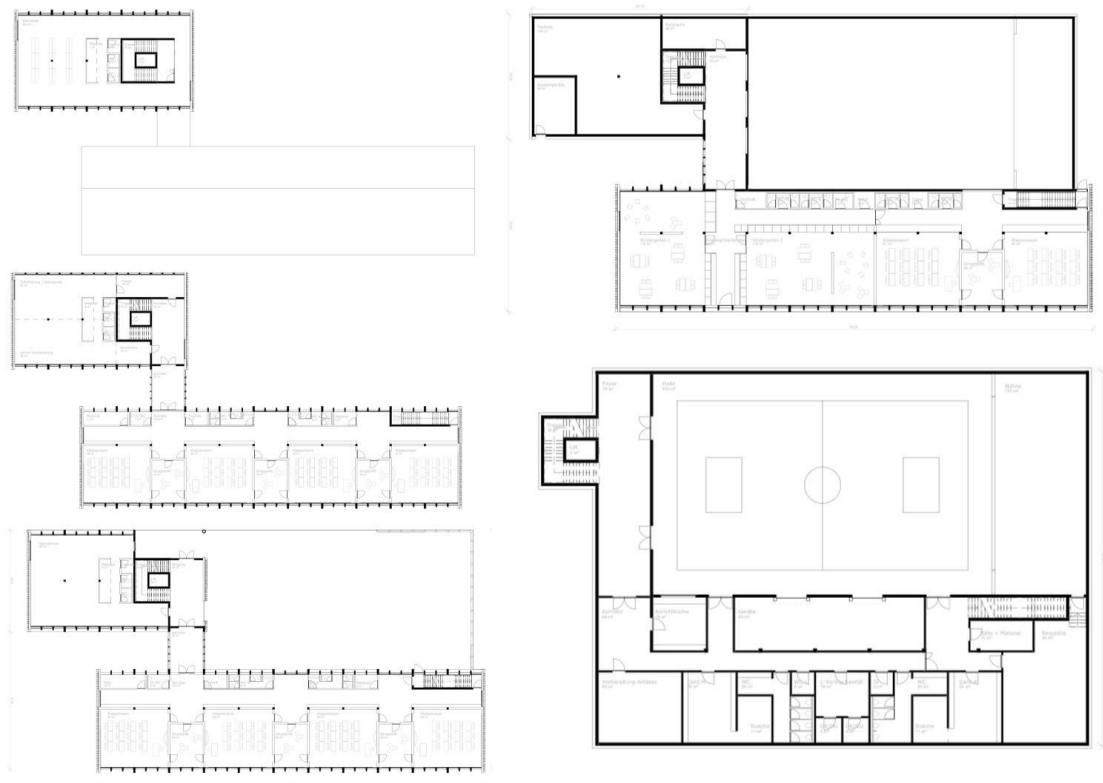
Grundrisspläne 1./2./3. Obergeschoss (links), Erdgeschoss und Untergeschoss (rechts) (Stand: Richtprojekt Januar 2024)
